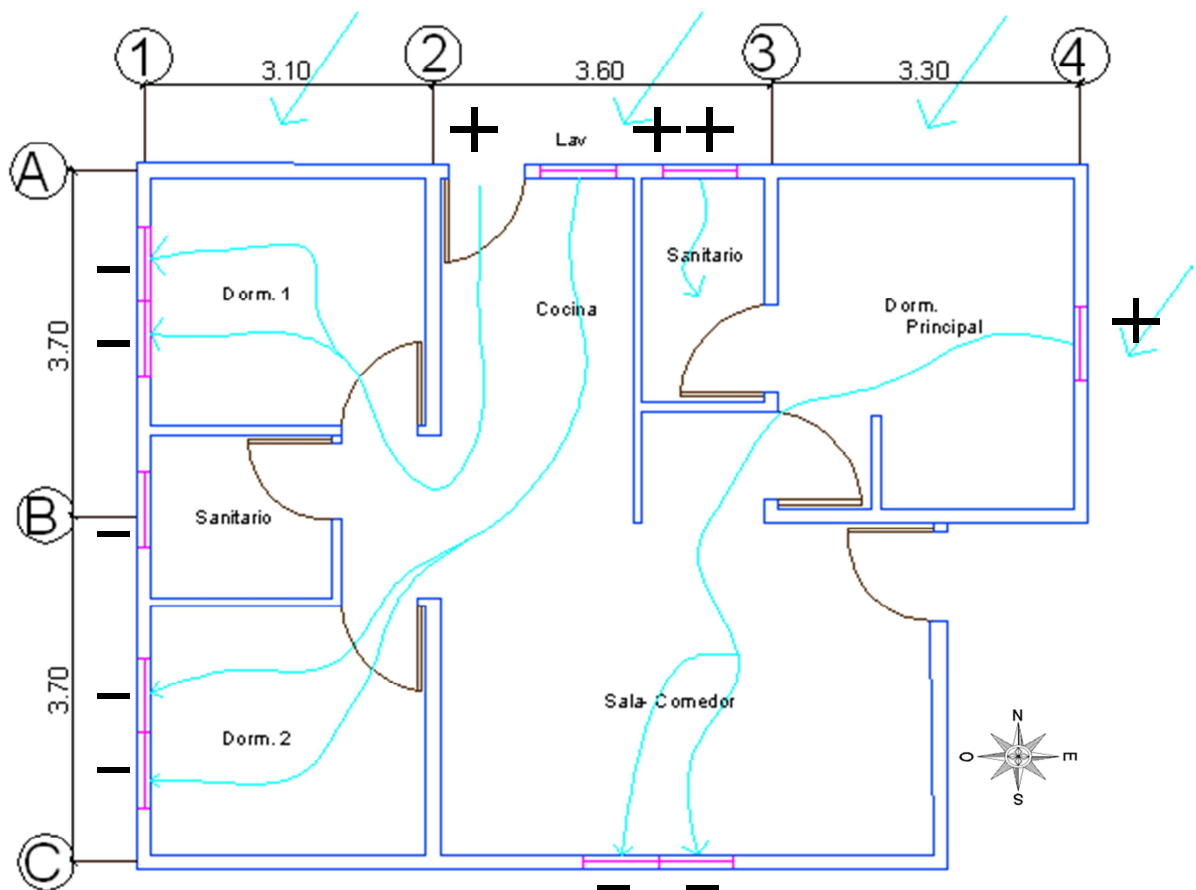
Ventilación cruzada en planta modelo 2 Petrocasa
